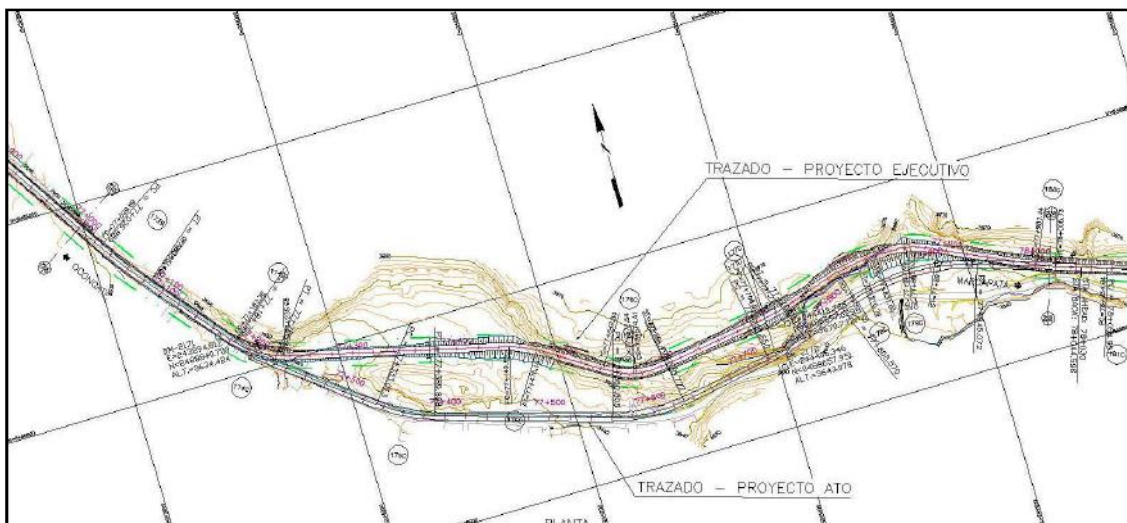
Geometria - Planta com os Traçados do Projeto Executivo e Projeto ATO.
